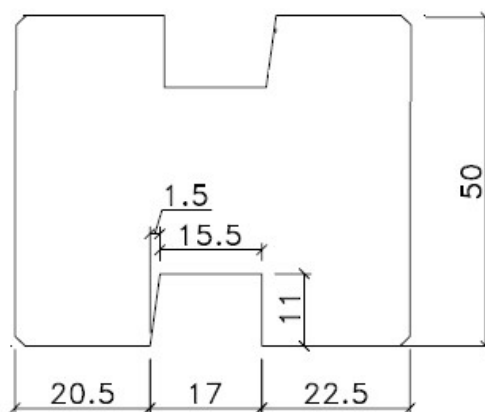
Section de poteau rectangulaire avec feuillure
